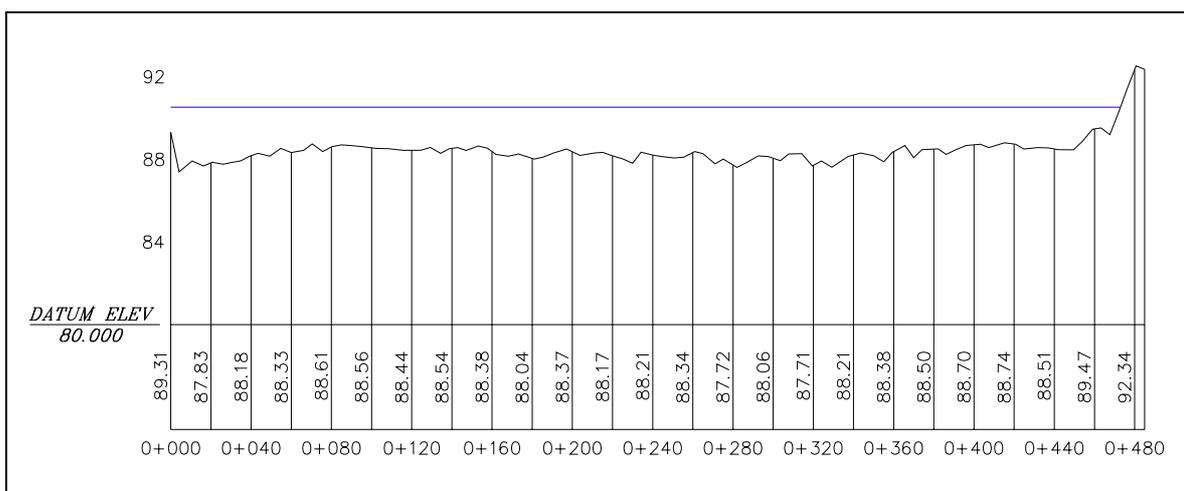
Sección crítica del mal paso Santa Fe (Canal Madre)
